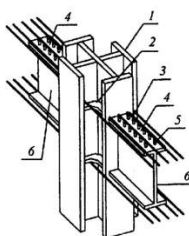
Соединение внахлест между продольной арматурой балки и короткими стальными балками: 1 - профиль в колонне; 2 - исход воздуха; 3 - внахлест продольной арматурой; 4 - бетонные балки с профилем; 5 - болты; 6- двутавр
